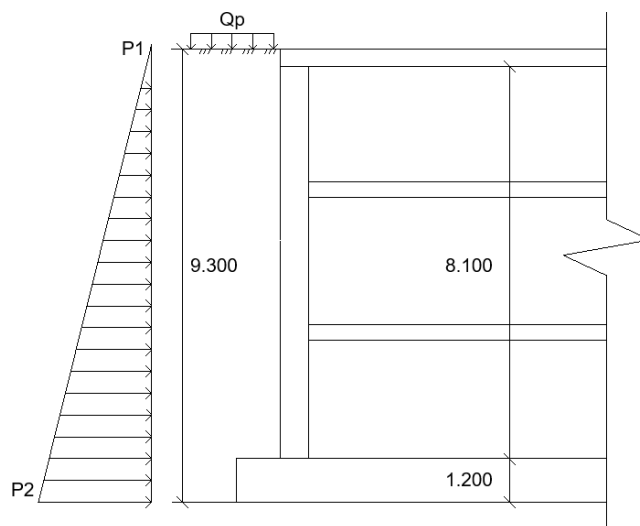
Схема определения давления грунта на стену подвала
